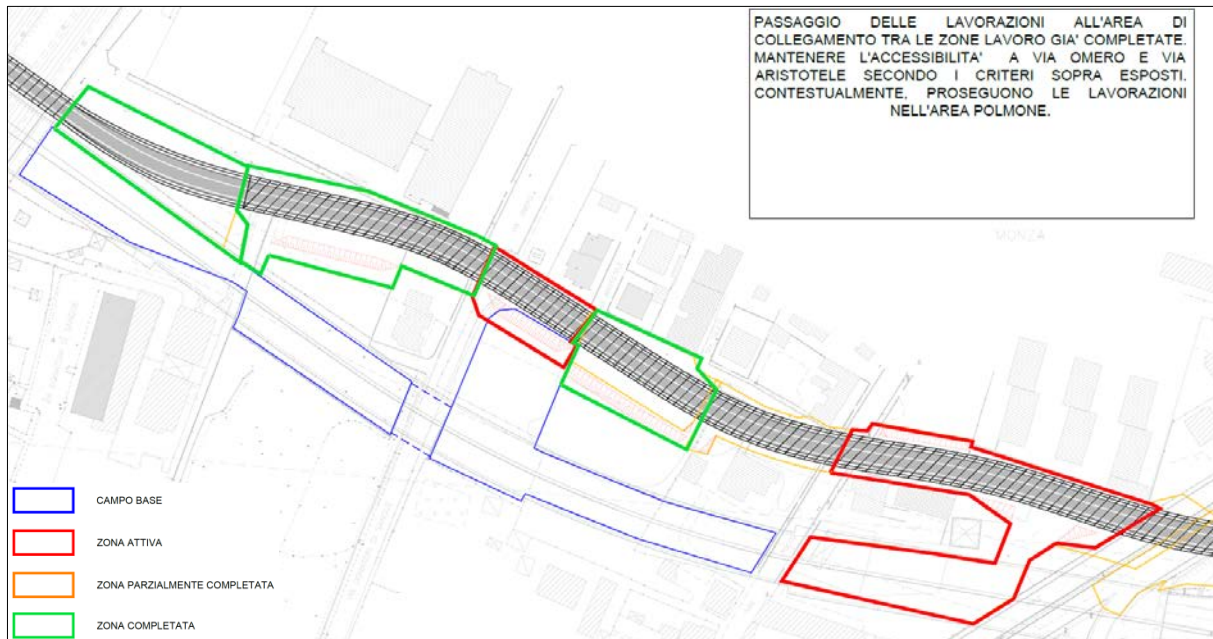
Fasi realizzazione copertura galleria del Piano di Sicurezza di progetto illustrativo della fase E di scavo della galleria
